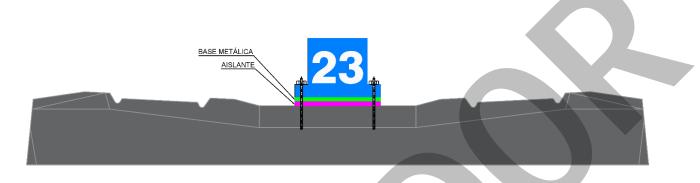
Módulo de identificación de vía situado en el centro de una traviesa de hormigón.
